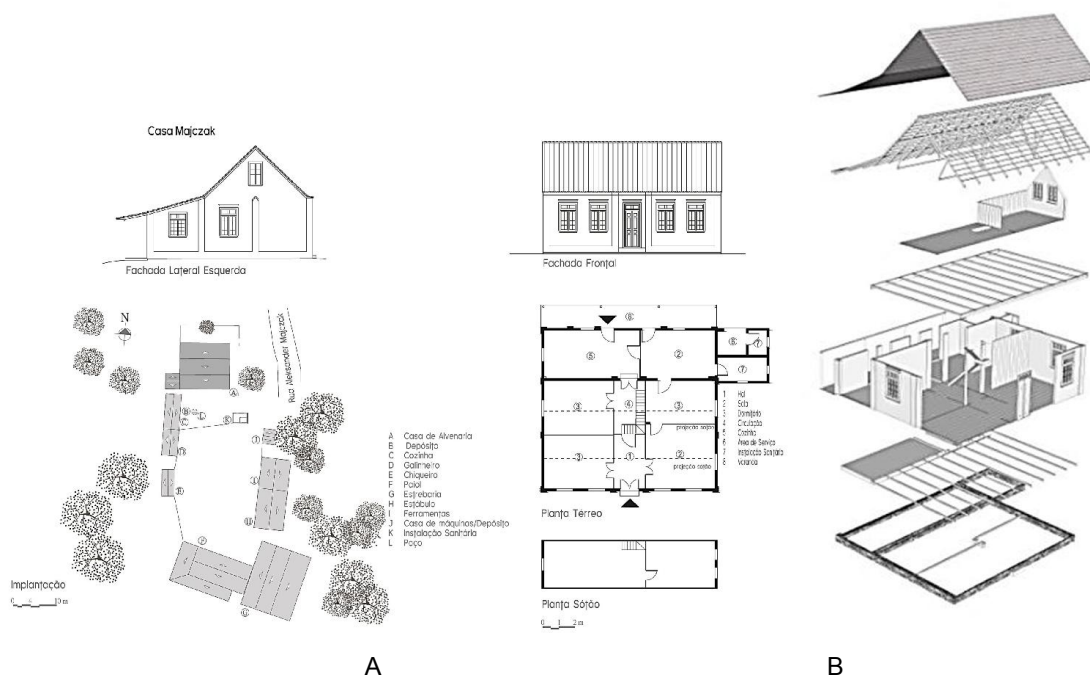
IMPLANTAÇÃO, PLANTAS E FACHADAS (A) PERSPECTIVA DA CASA MAJCZAK (B)
